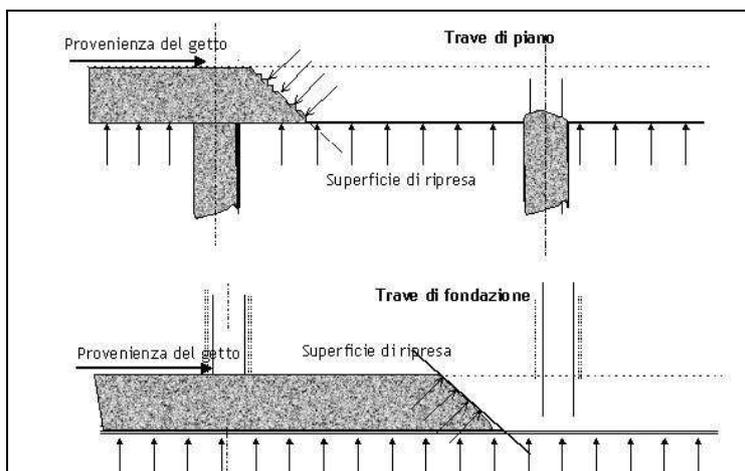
Ripresa di getto in travi di piano e di fondazione
